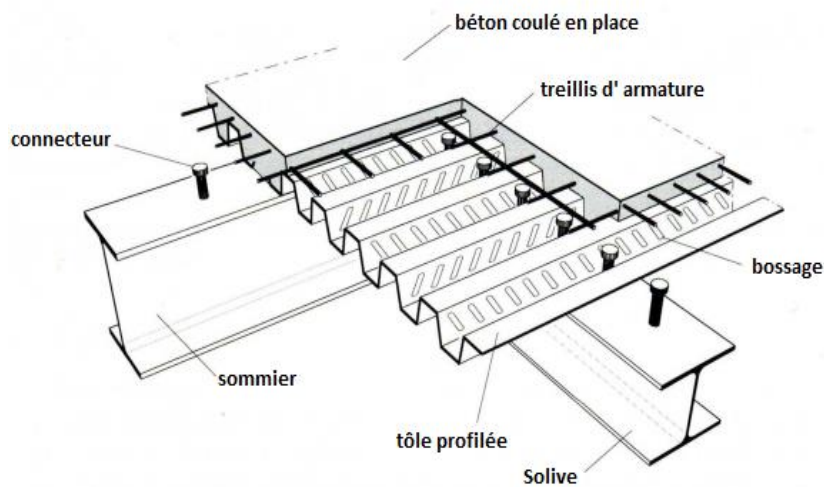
Plancher mixte avec connecteurs acier-béton [7].
